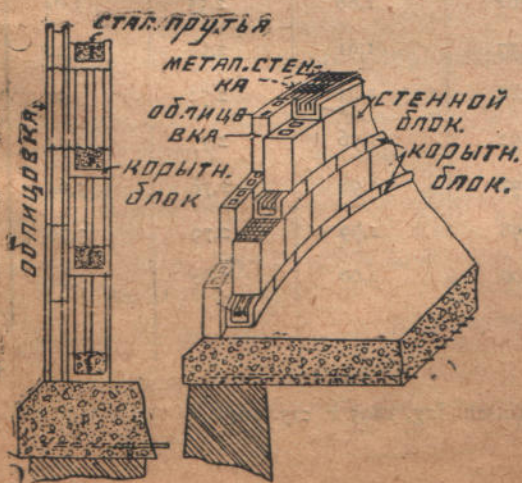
Деталь устройства стенки силоса из специальных бетонных блоков с арматурой.
